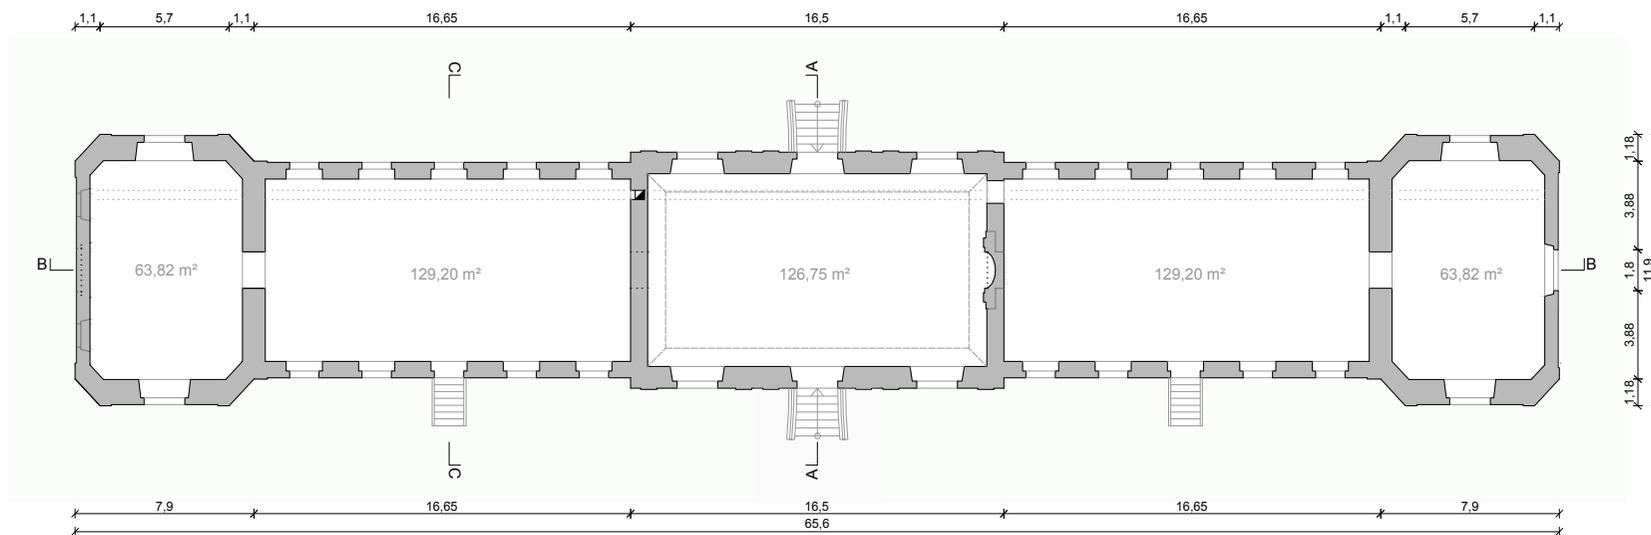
Gartengebäude, Erdgeschoss, gezeichnet von Verf. nach Klaar-Plan, M 1:150.
